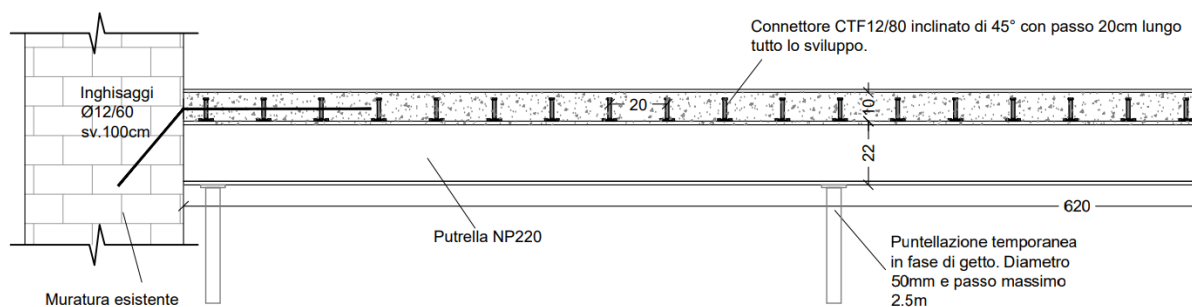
disposizione lungo la luce di solaio rinforzato con cappa collaborante dei connettori a taglio per recupero dell'Ex Istituto Mondino a Pavia (lavori di Studio Calvi BEAM BEAM).
